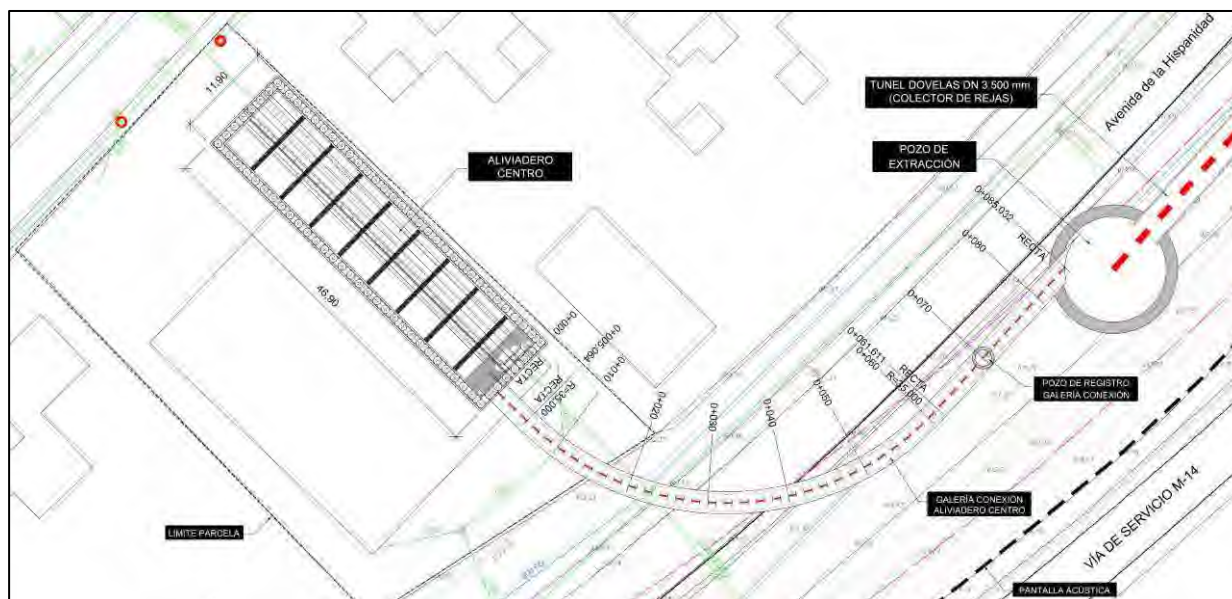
Aliviadero Centro, galería de conexión al colector de pluviales y pozo de extracción. Planta.
